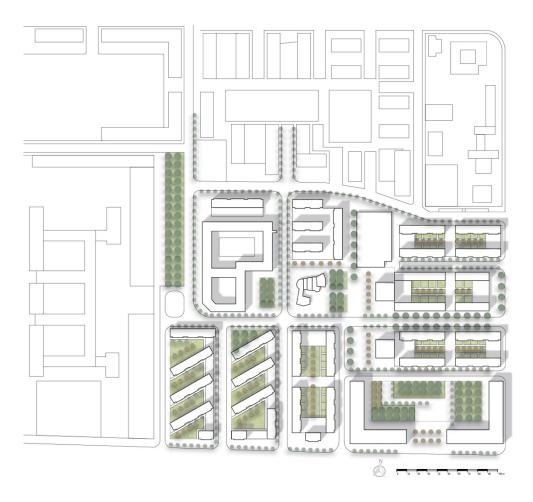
Plano planta nueva tipología. Fuente: elaboración propia.
